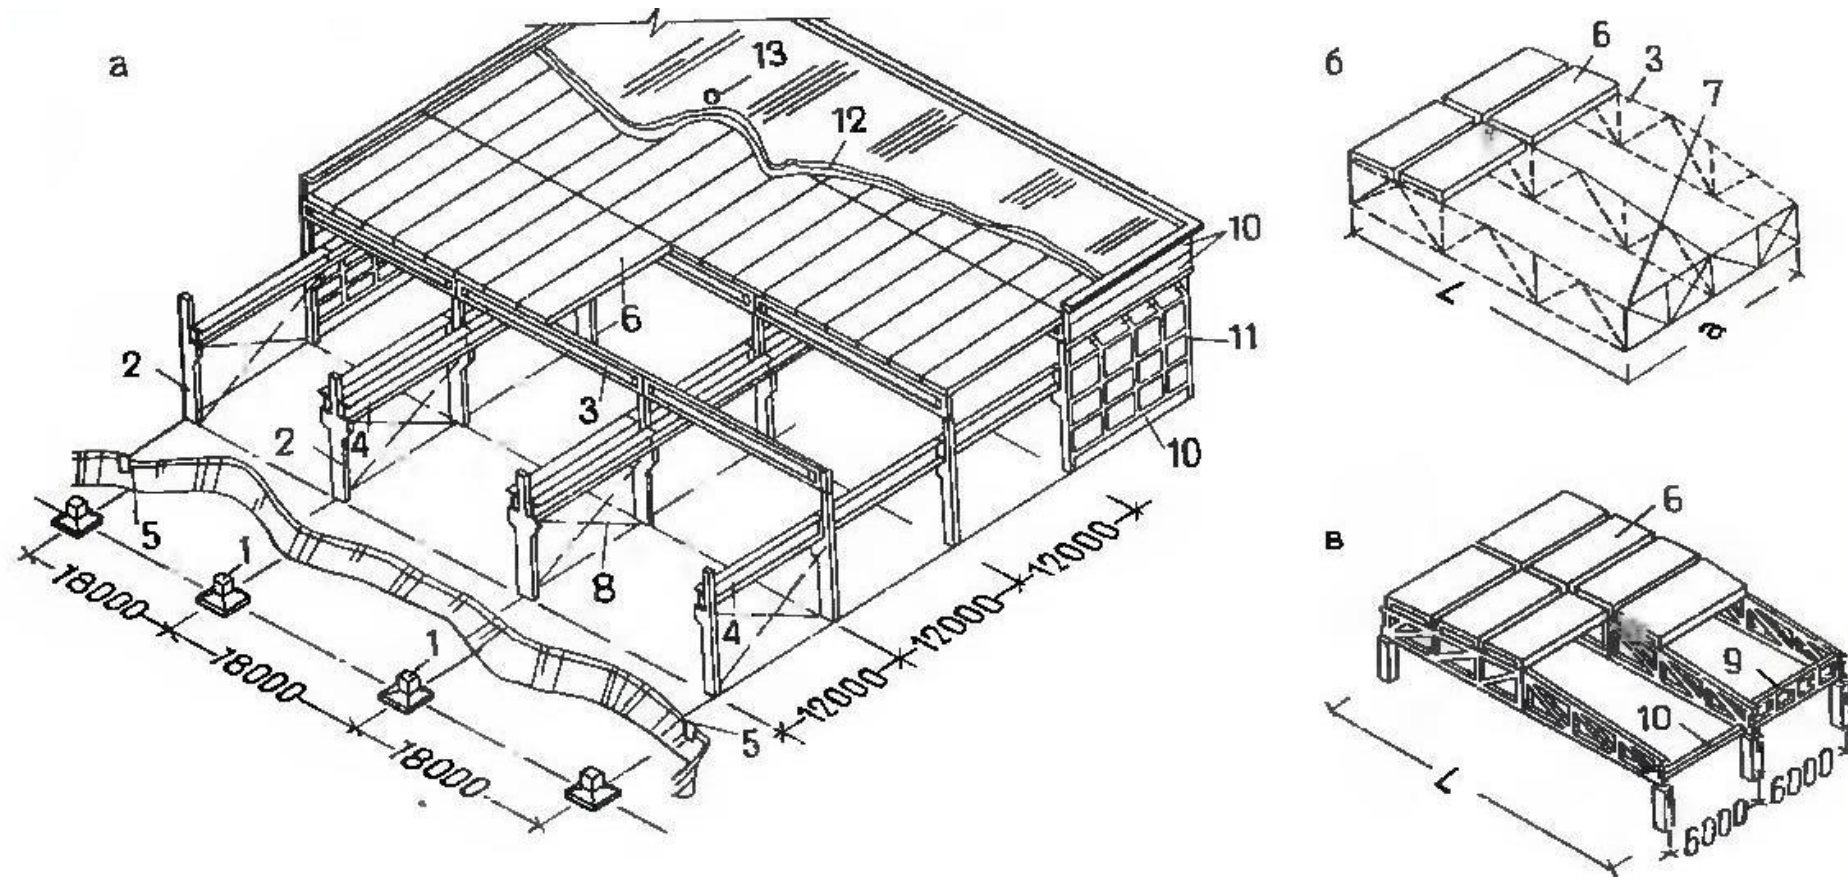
Основные элементы каркаса одноэтажного промышленного здания. а - общий вид; б - схема устройства подстропильных конструкций; в - схема устройства вертикальных связей в покрытии: 1 - фундамент под колонну, 2 - колонна каркаса, 3 - ригель (балка или ферма), 4 - подкрановая балка, 5 - фундаментная балка; 6 - несущая конструкция ограждающей части покрытия плиты; 7 - подстропильная ферма; 8 - вертикальные связи между колоннами, 9 - вертикальные связи в покрытии; 10 - наружная стена, 11 - оконные переплеты; 12 - — ограждающая конструкция покрытия (пароизоляция, термоизоляция и кровля). 13 - воронка внутреннего водостока.
